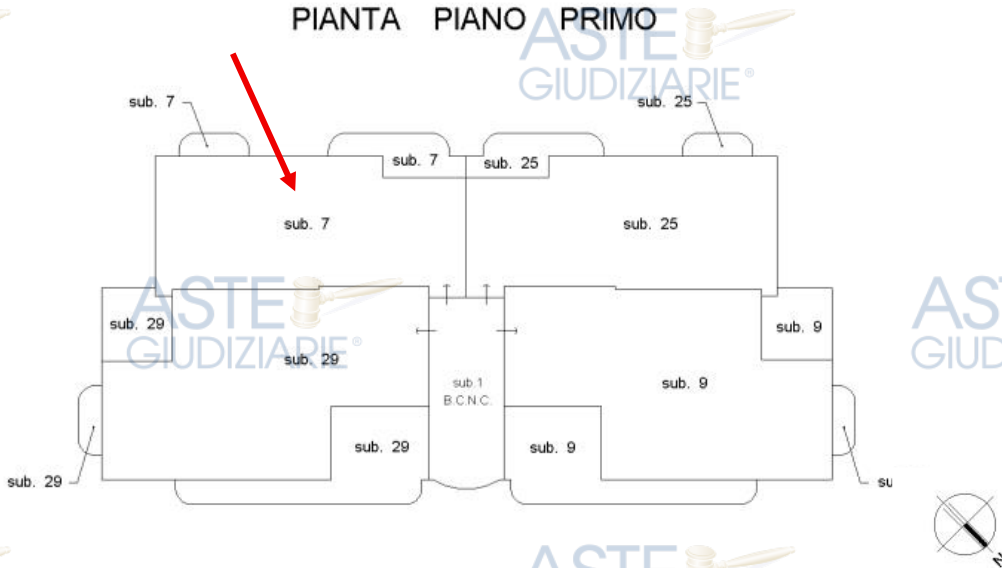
Estratto elaborato planimetrico con individuazione dell'unità immobiliare
